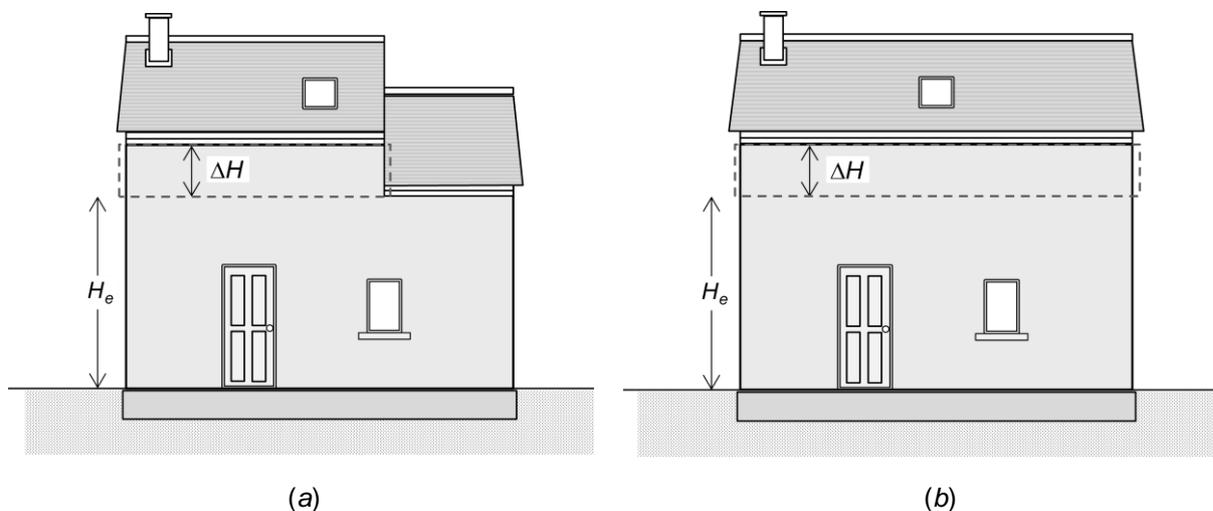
exemple de la surélévation (a) partielle et (b) entière d'une toiture
